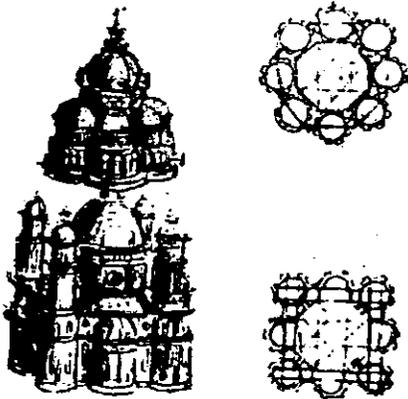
Trazo de iglesia en planta y volúmen, elaborado por Leonardo.
